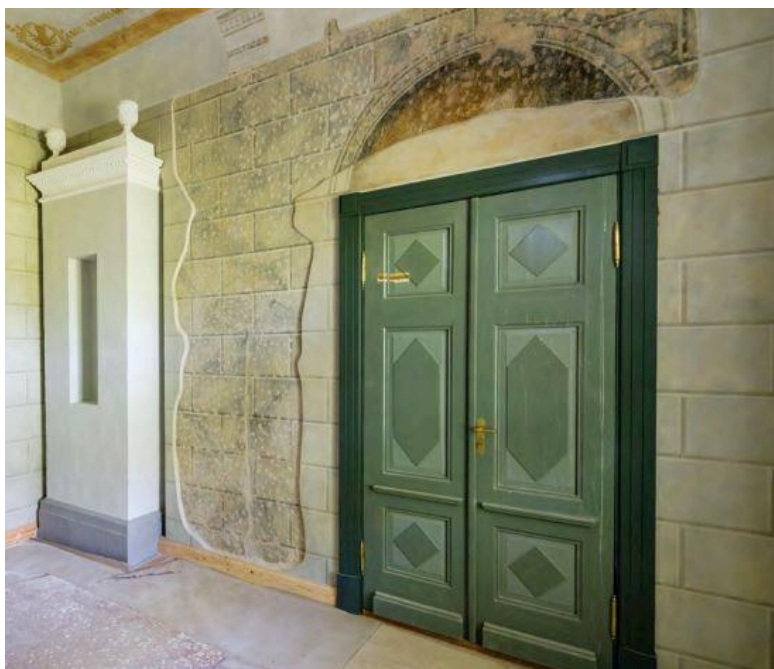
Restaureeritud kvaadermaaling. Allikas: Aruküla kooli koduleht, 2016.
